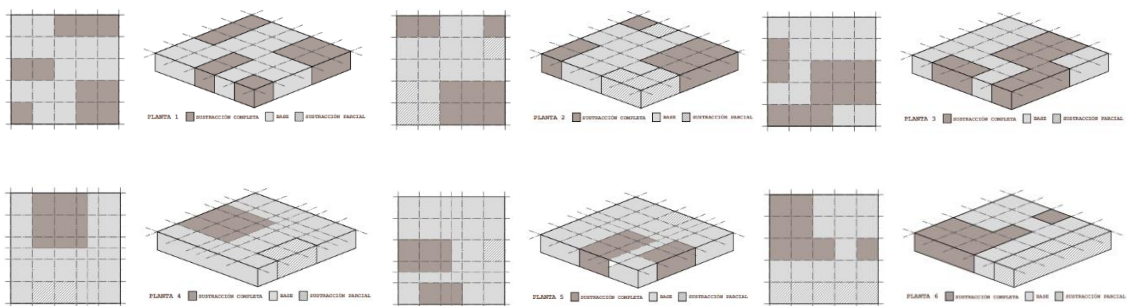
Esquemas de generación de la Planta siguiendo el módulo base
